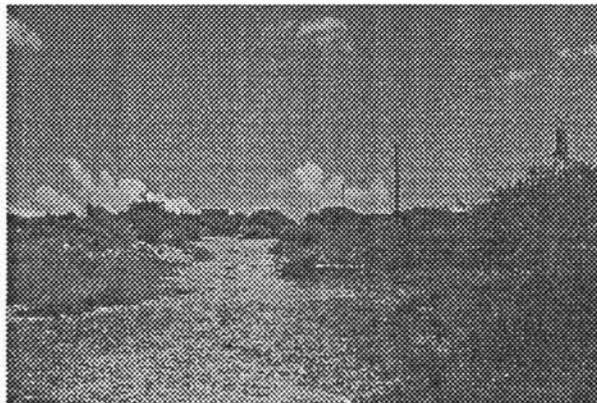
Acceso existente del lado oriente, el cual esta en proceso de pavimentación
